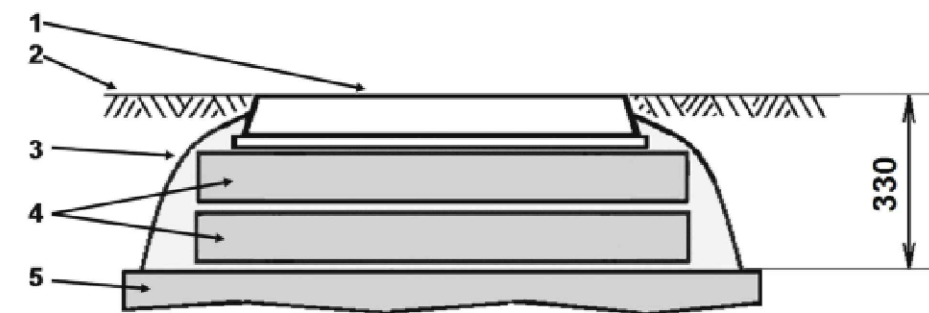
Расстояние от перекрытия колодца до уровня дорожного покрытия на проезжей части должно быть – не менее 330 мм: 1 – люк чугунный тяжёлого типа; 2 – уровень дорожного покрытия; 3 – обмазка горловины бетоном со щебнем; 4 – опорные кольца типа КО; 5 – перекрытие колодца «ККСр-3-80».
